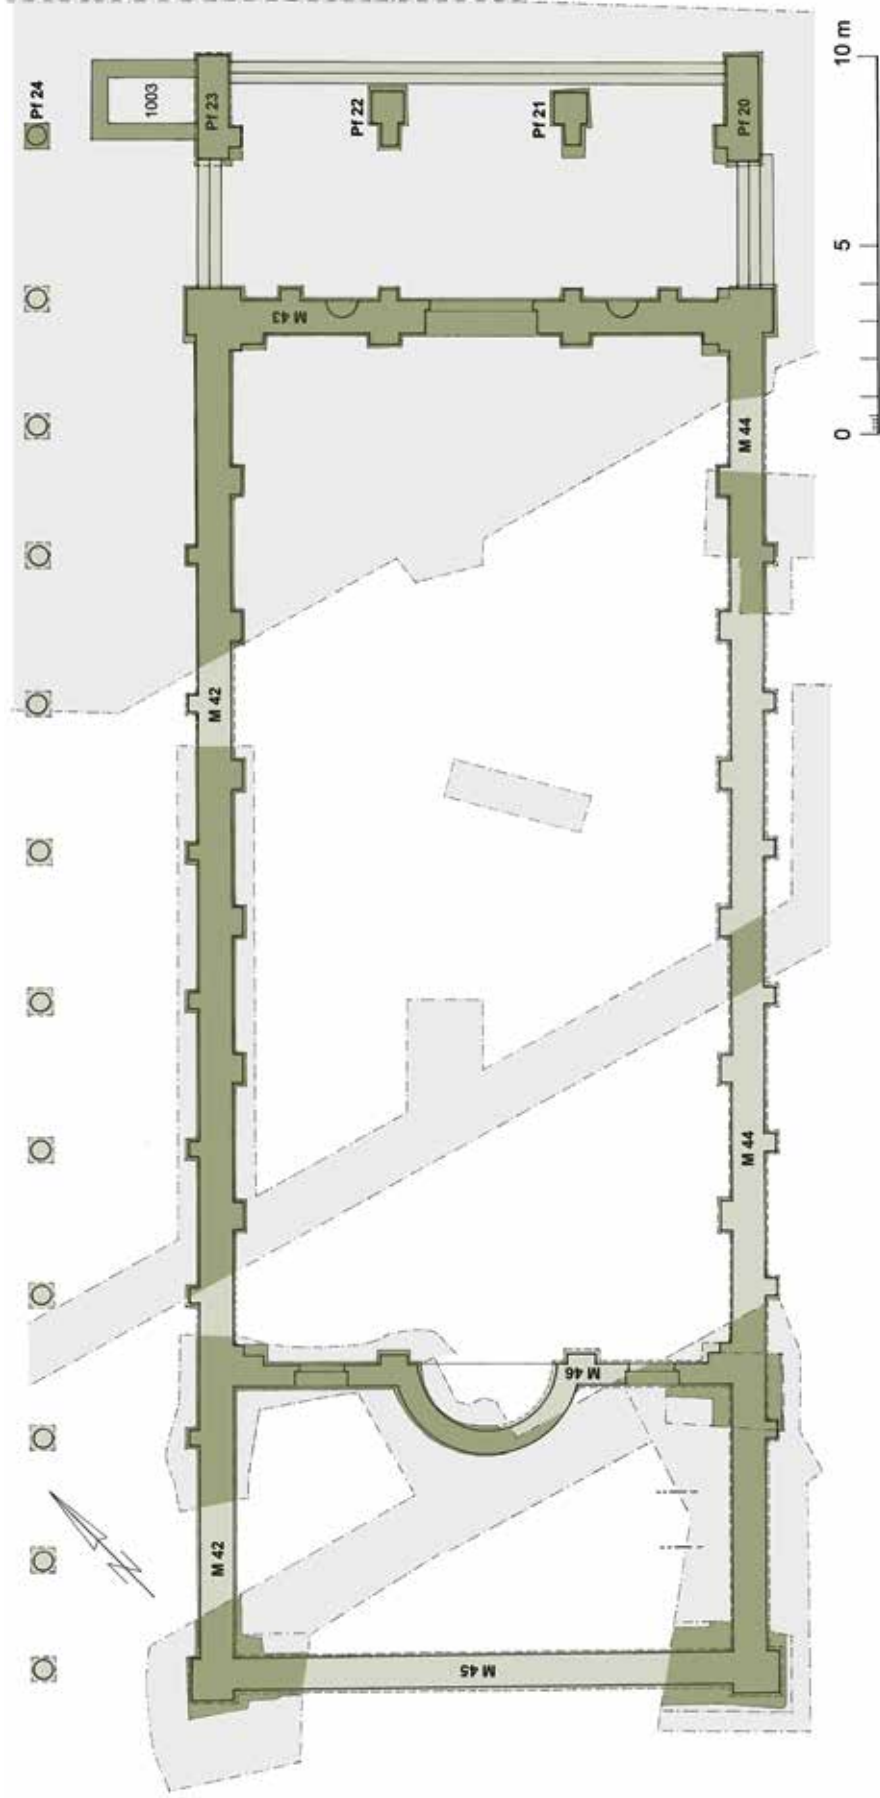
Periode 7, Apsidenbau, Grundriss, Rekonstruktion. – M. 1:200.
